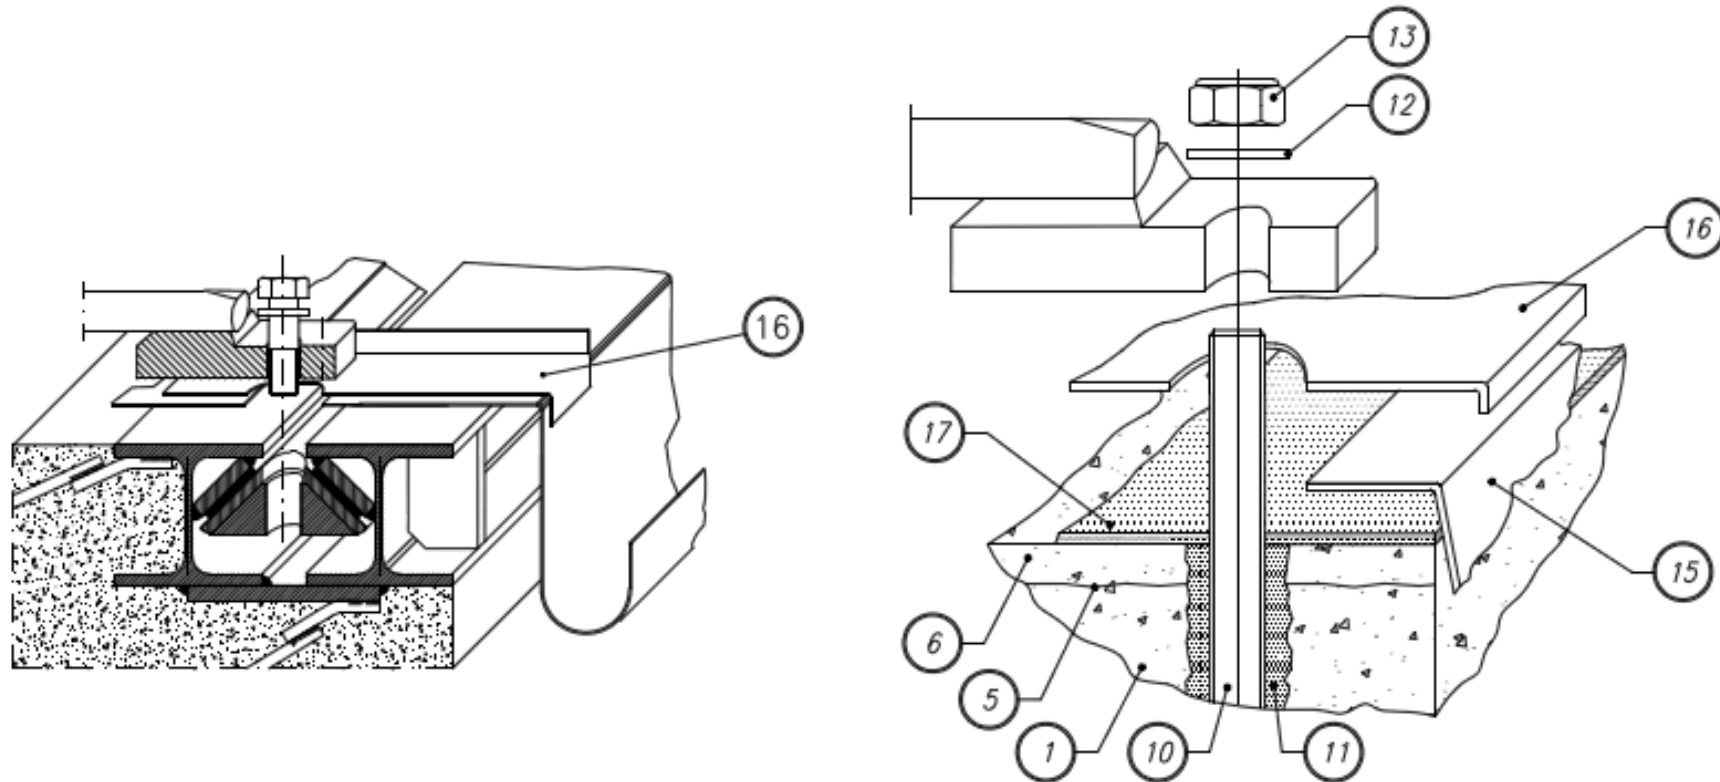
Конструкция деформационного шва между железобетонными плитами пролетного строения моста
